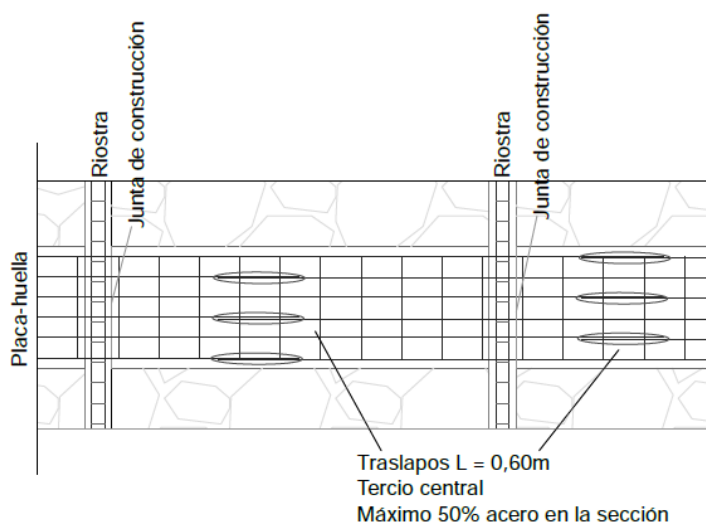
Junta transversal de construcción de la placa-huella (vista en planta).
